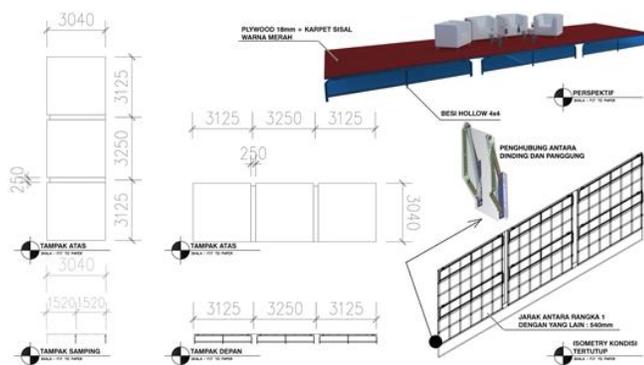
Detail Elemen Interior Lantai di Lapangan Futsal
